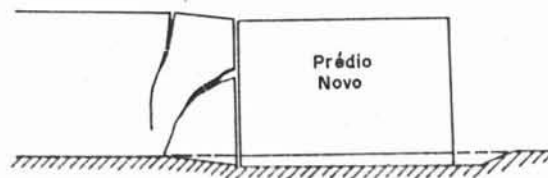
Recalque proveniente da sobrecarga da construção limdeira, executada sobre radier (MAÑA<sup>64</sup>).
